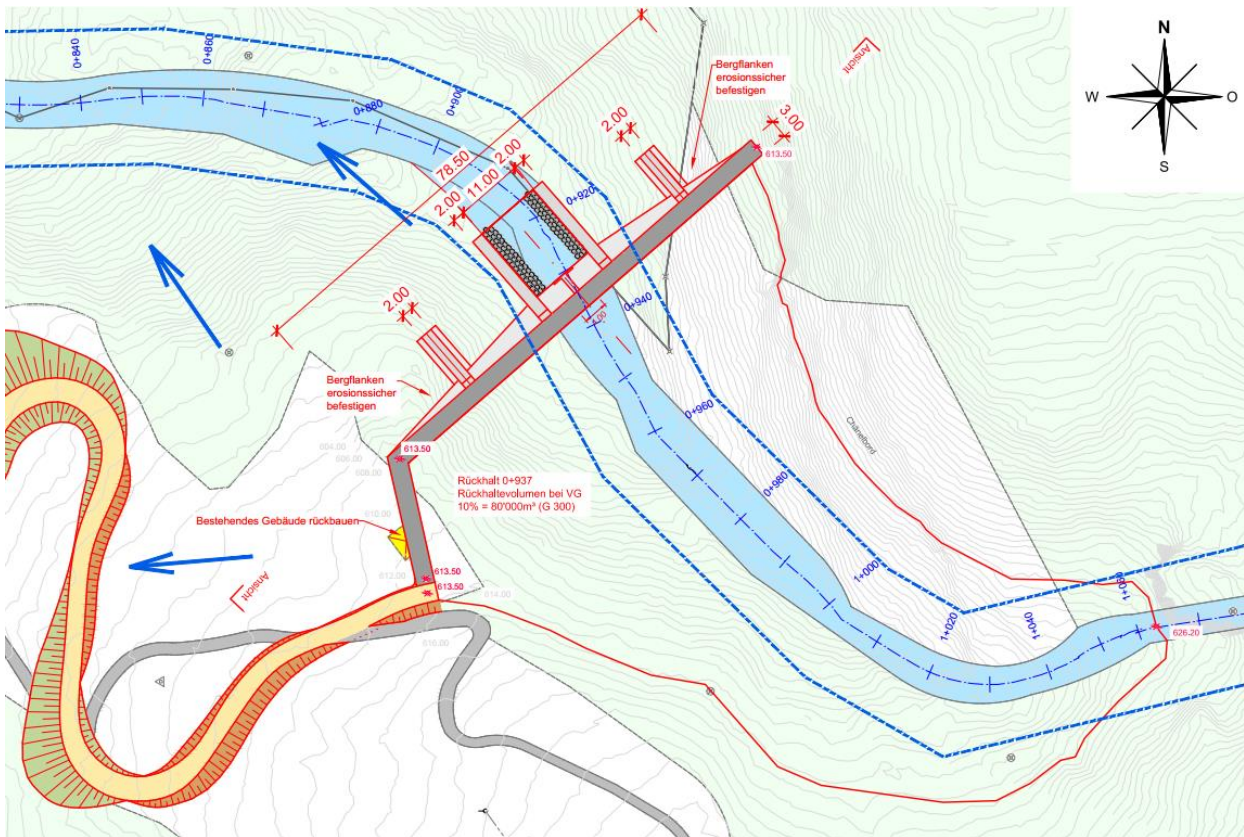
Projektiertes Rückhaltebauwerk bei km 0+937
